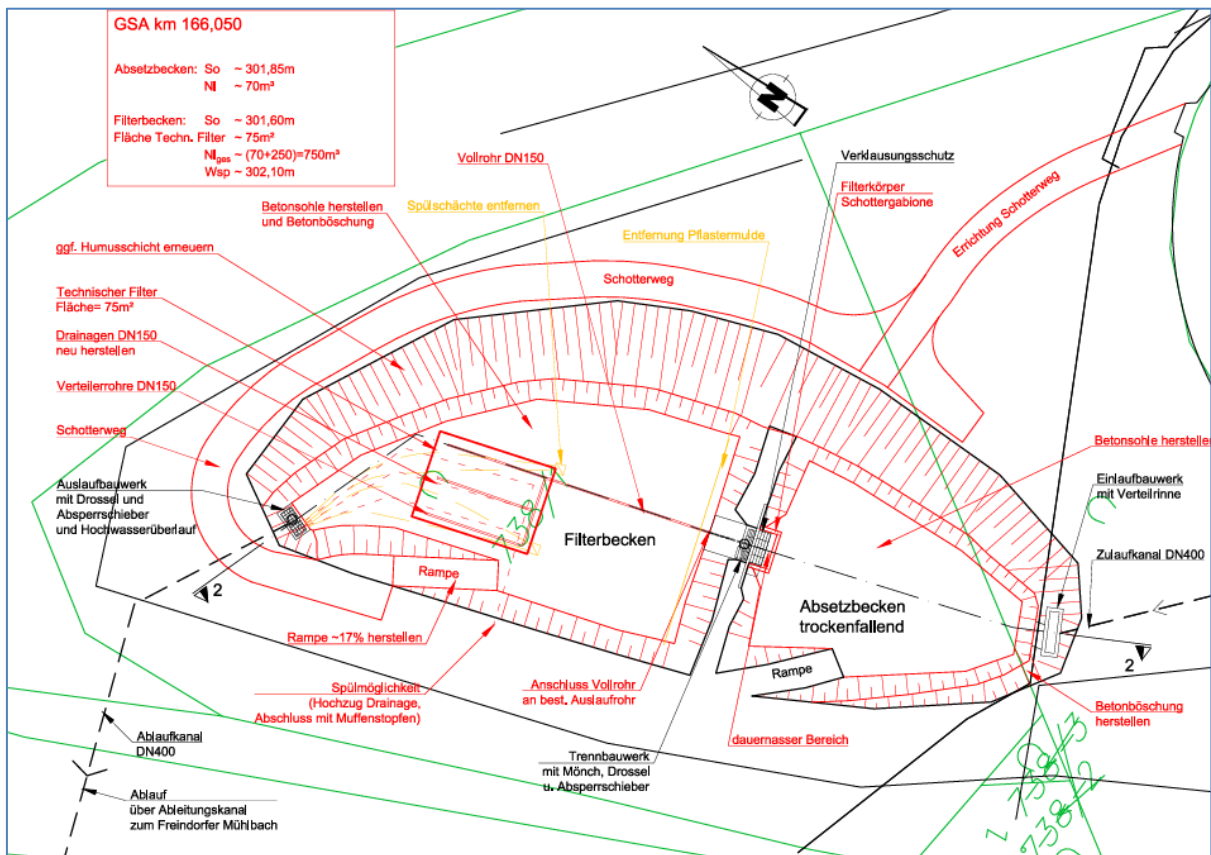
Grundriss der Gewässerschutzanlage Mühlbach (Quelle: Asfinag)
